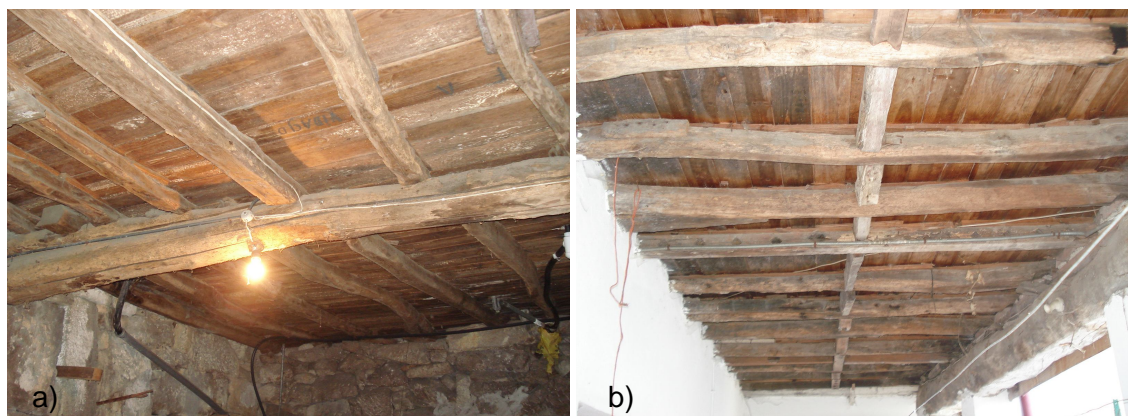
a) e 4.9 b): a) Vista inferior do pavimento interior; b) Vista inferior do pavimento exterior.
